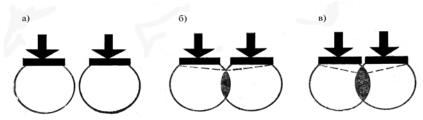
Взаимное влияние двух фундаментов зданий: а – зоны напряжений не перекрываются; б, в – зоны напряжений перекрываются [6]. ВЫВОДЫ
